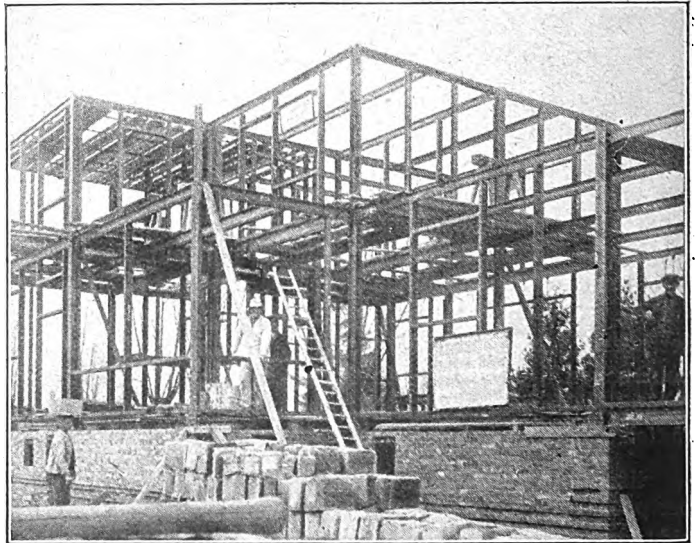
Stahlskelett für ein Wohnhaus in Breslau-Grüneiche
